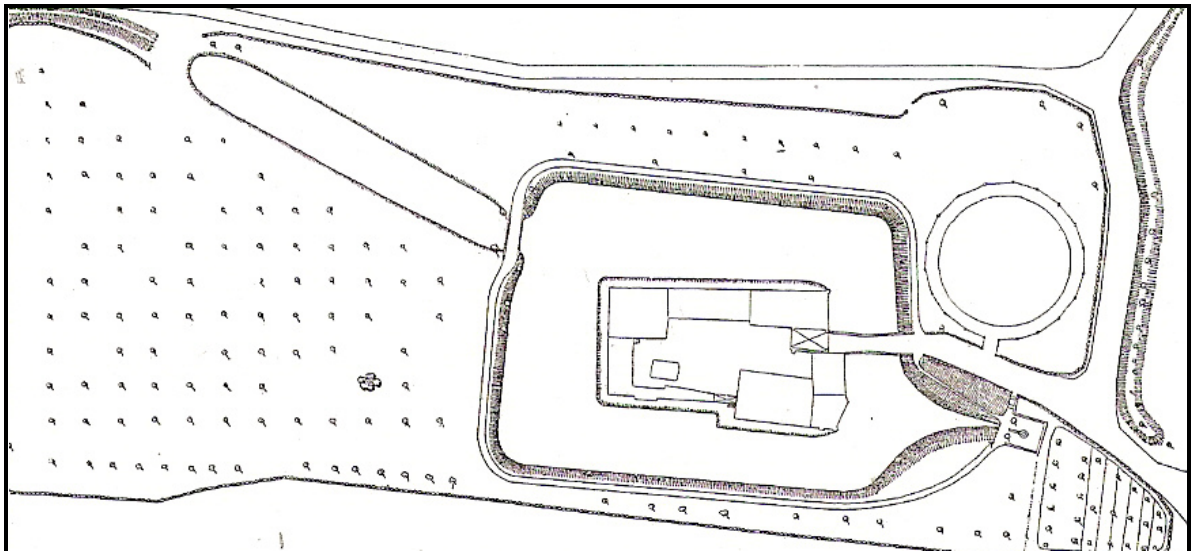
Kühhorn's Hof; Grundriss nach einer Aufnahme von 1863
